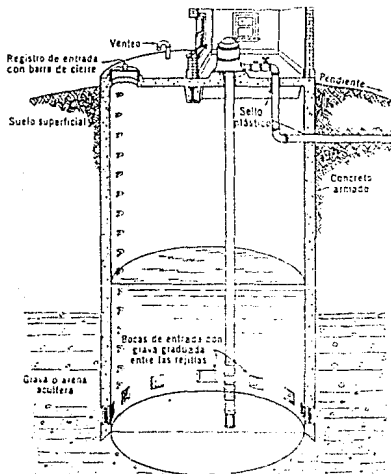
POZO CAVADO CON REVESTIMIENTO DE CONCRETO.
